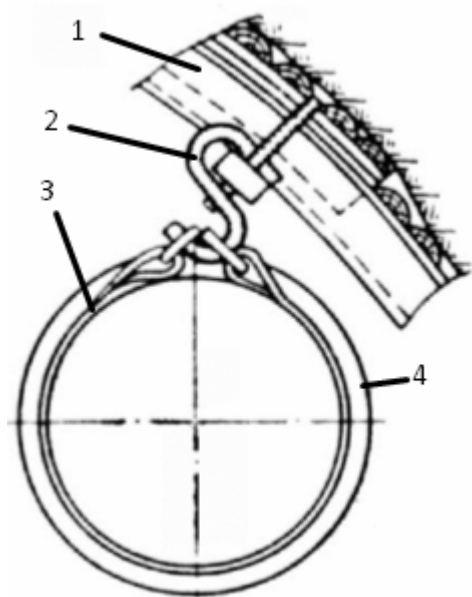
Схема подвески труб на хомутах и крючьях: 1 – рама крепи; 2 – крюк; 3 – хомут; 4 – труба.
